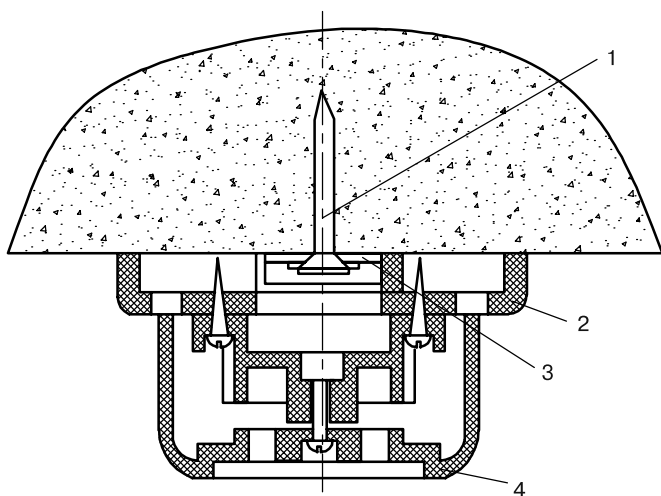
Установка штепсельной розетки на строительном основании (железобетонном, кирпичном) с применением пластмассового подрозетника:
